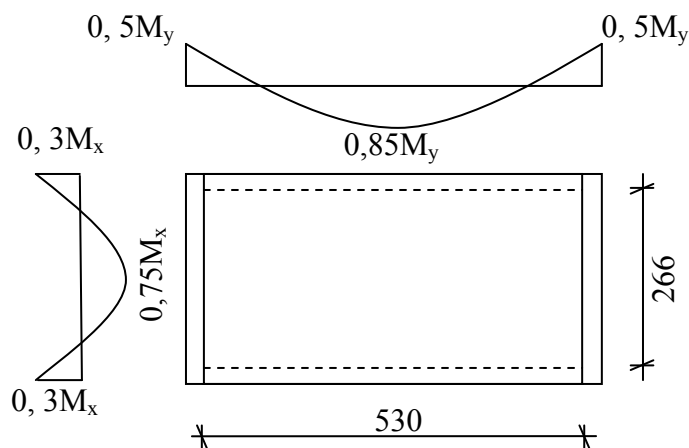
Panneau de dalle appuie sur 4 coté
